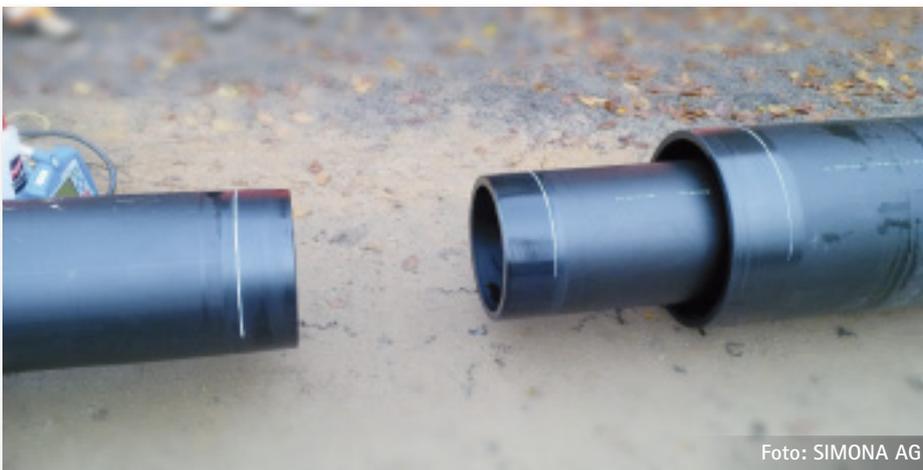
Vorbereitung zum Verschweißen des Innenrohres:
